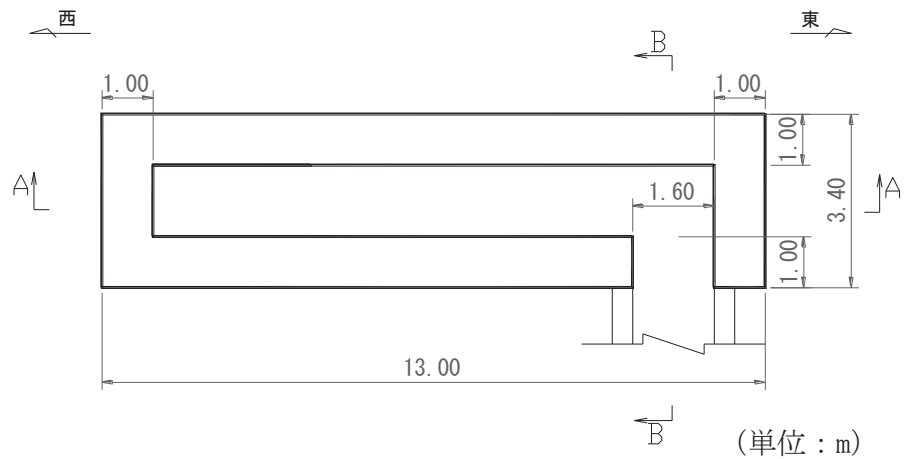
第 3 号機補機冷却海水系放水ピット平面図 (E-E 断面)
